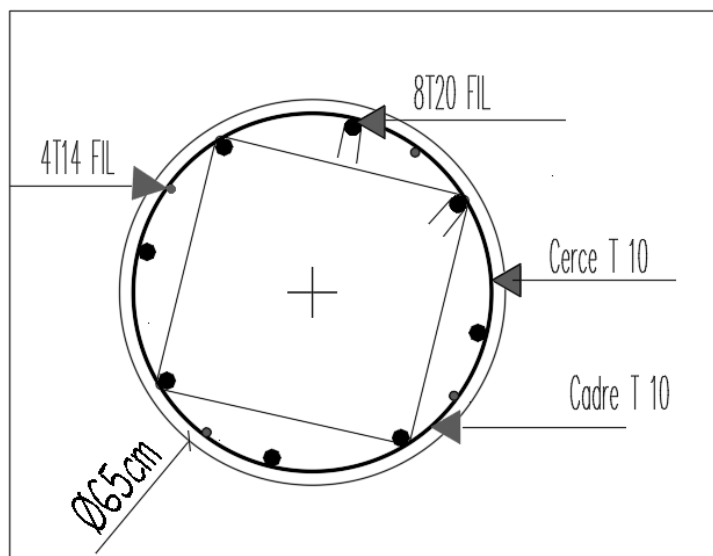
le schéma de ferraillage des poteaux D65cm
